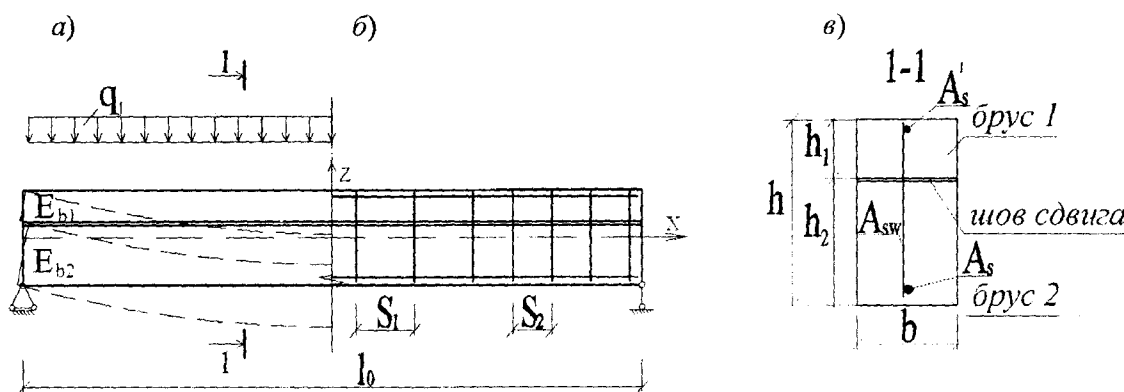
Расчетная схема (а), схема армирования (б) и поперечное сечение (в) составной железобетонной балки
